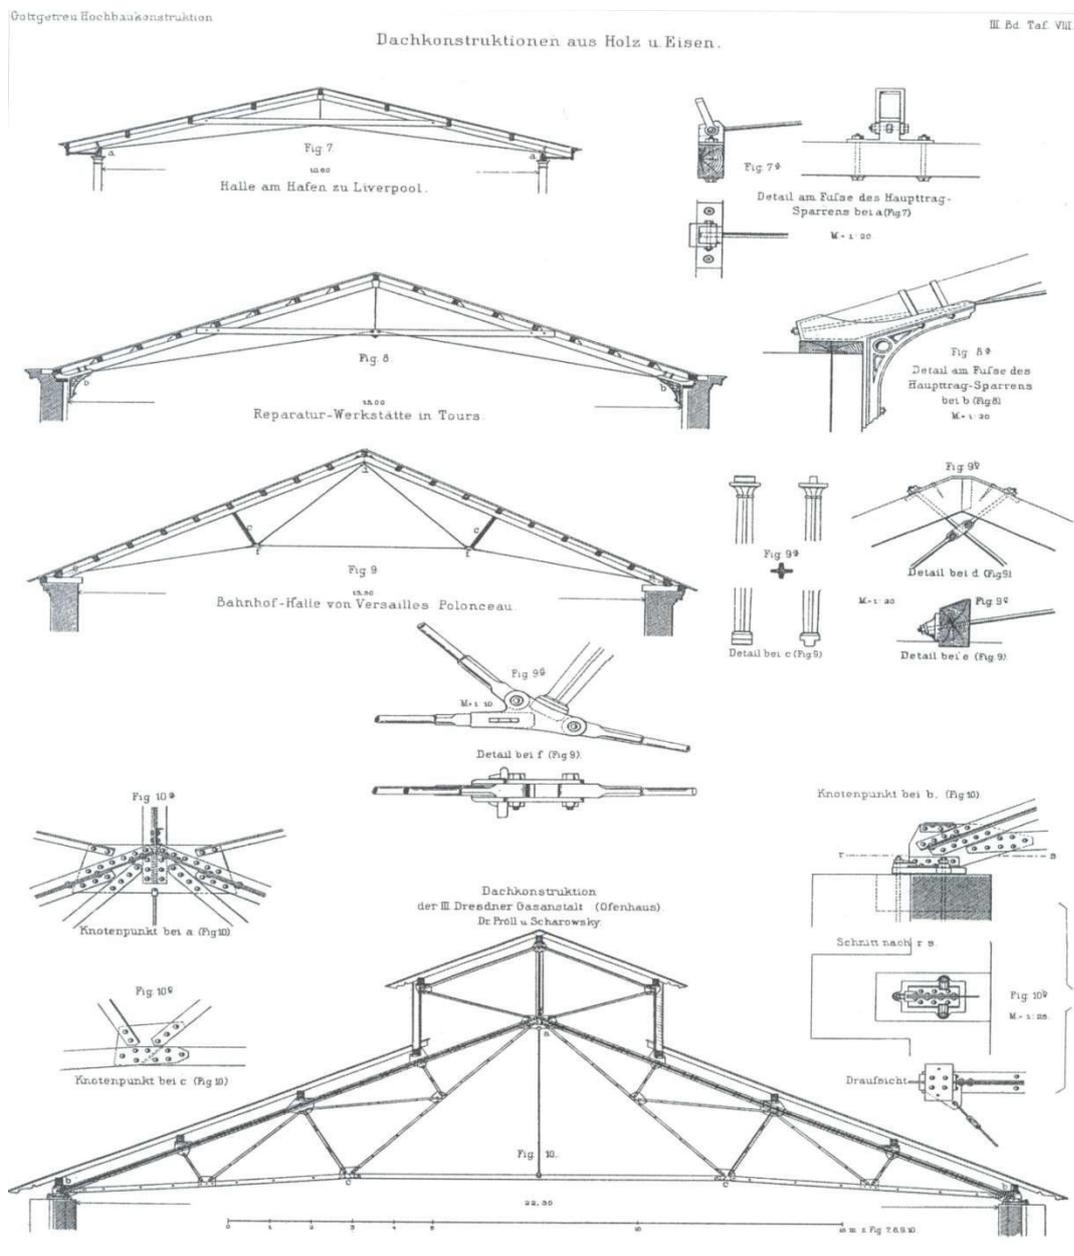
Dachkonstruktionen aus Holz und Eisen [21]
